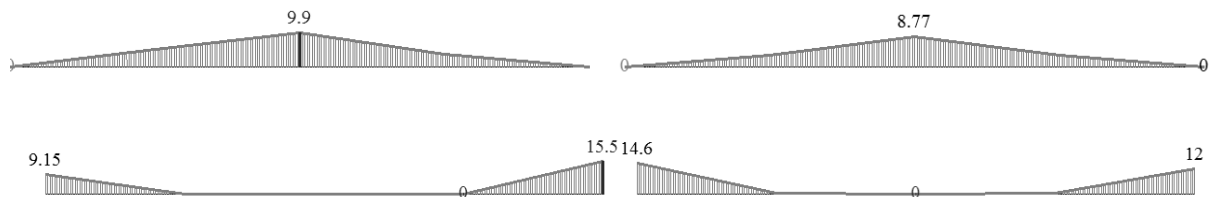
Эпюры требуемого армирования, а – нижнее армирование, б – верхнее армирование
